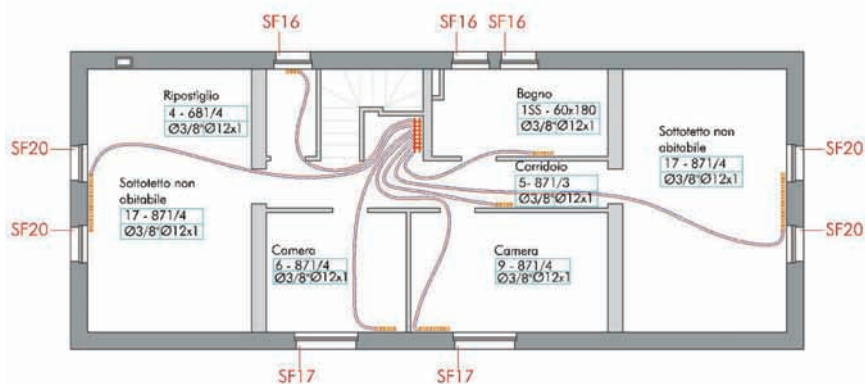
Distribuzione dell'impianto termico al piano primo
